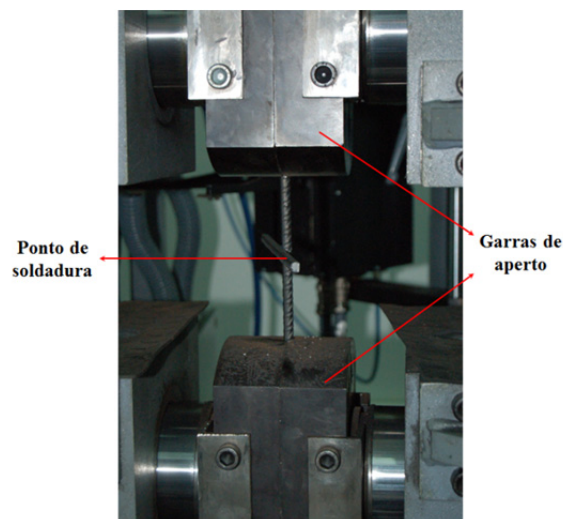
Provete tipo 3 colocado na máquina de ensaios de tracção para o ensaio oligocíclico
